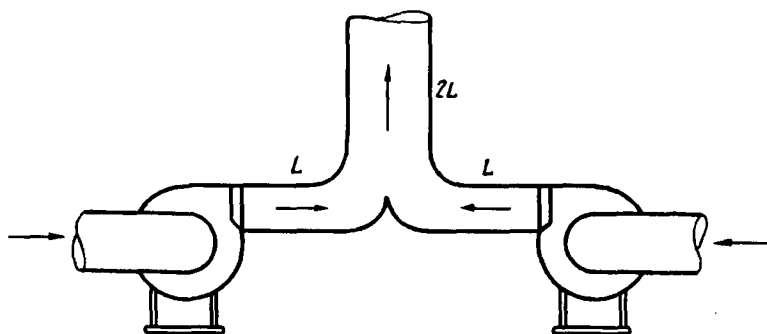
Схема параллельного соединения двух вентиляторов
